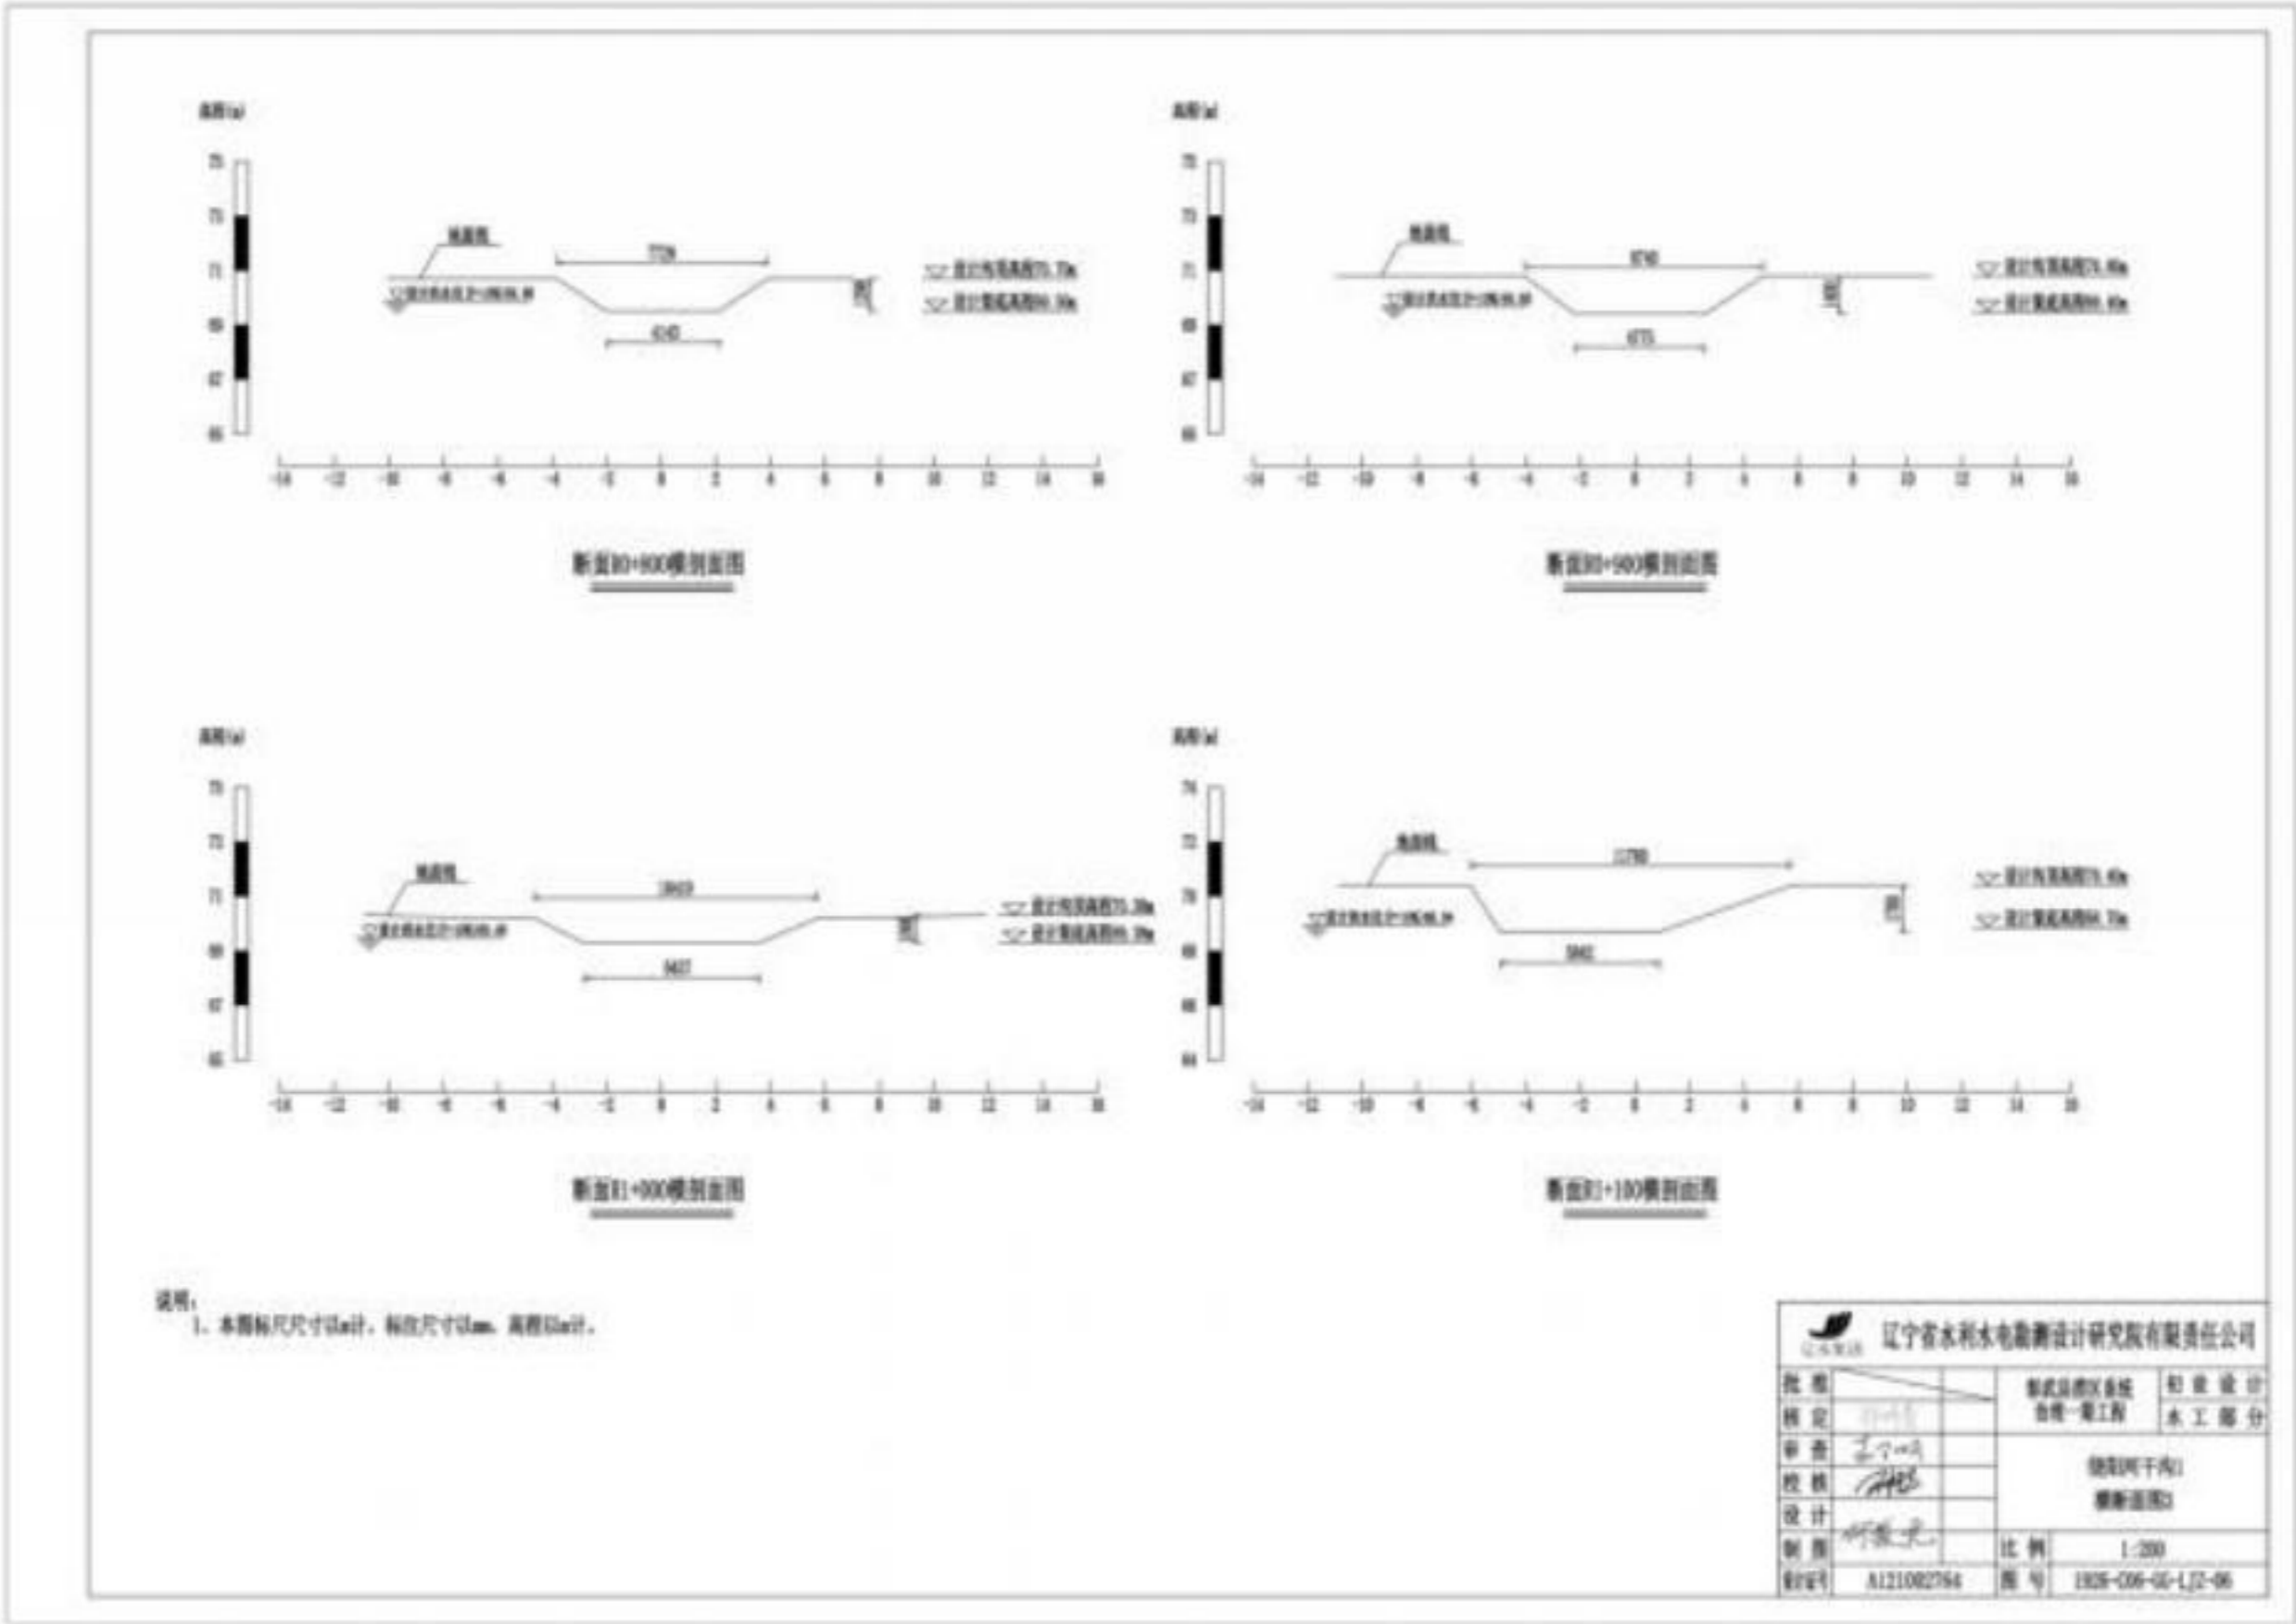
(3) 两家子镇绕阳河干沟 1 剖面图
